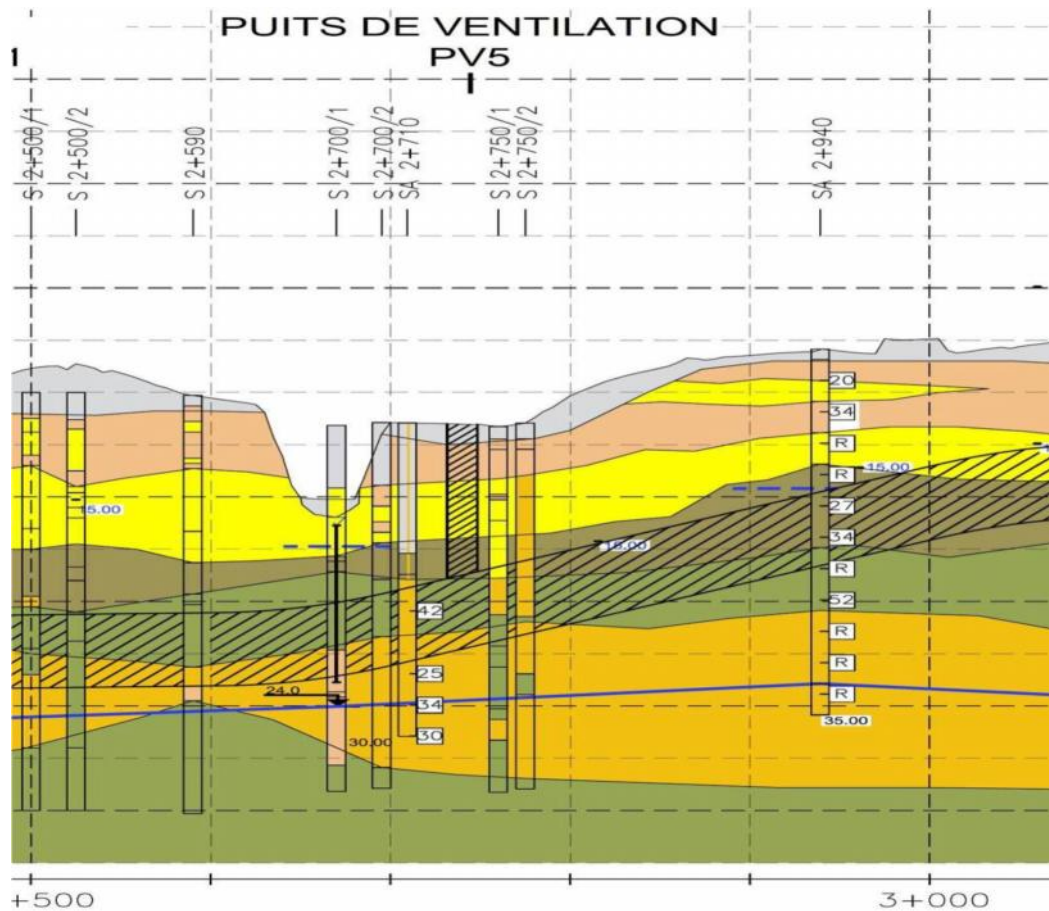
Coupe géologique autour de Puits de Ventilation 5
